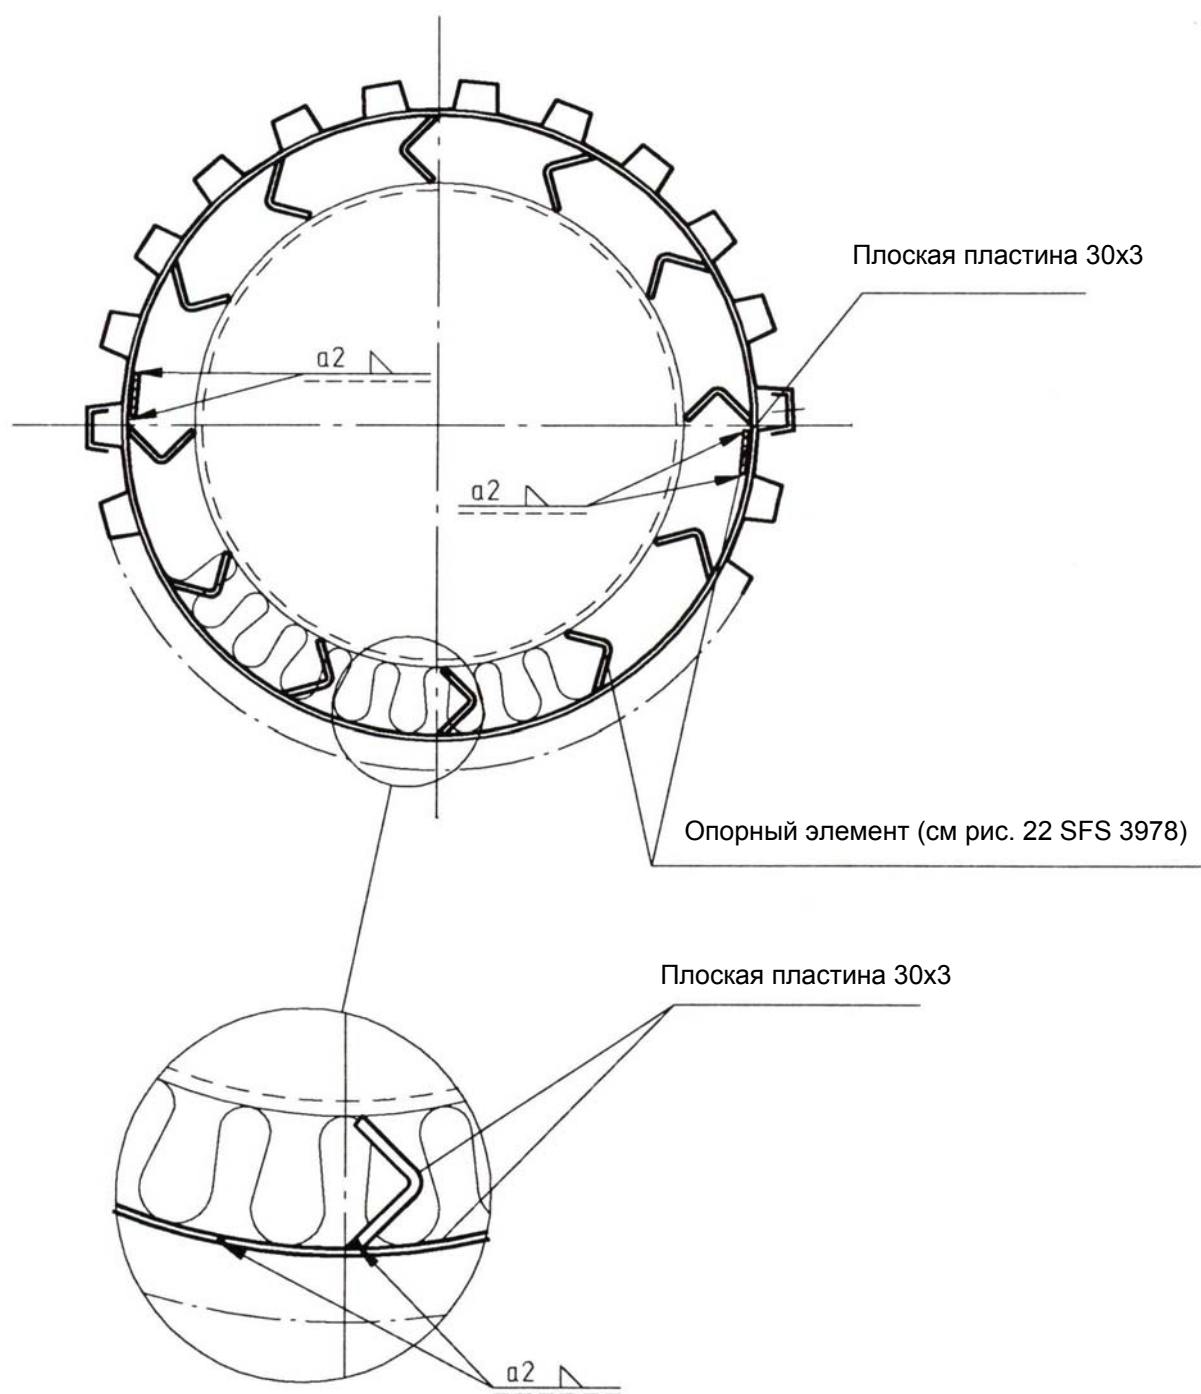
а Изоляция воздухопроводов и газоходов круглого сечения с покровным слоем из профилированного металлического листа
